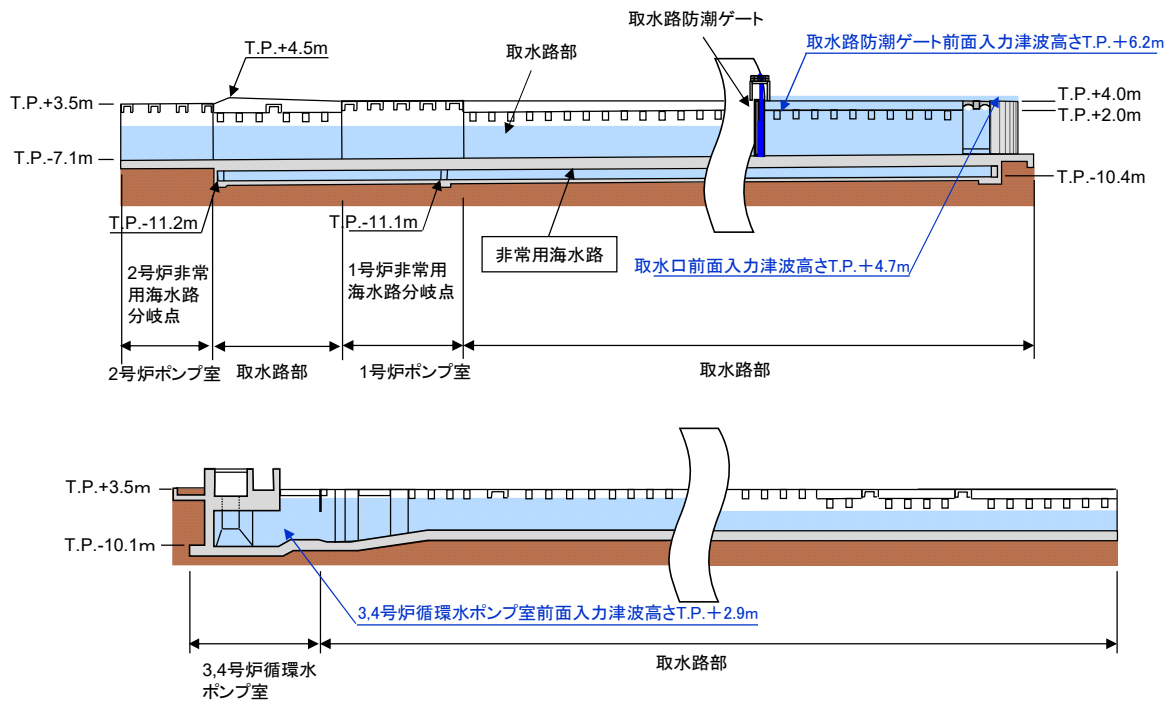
取水口から3,4号炉循環水ポンプ室断面図
